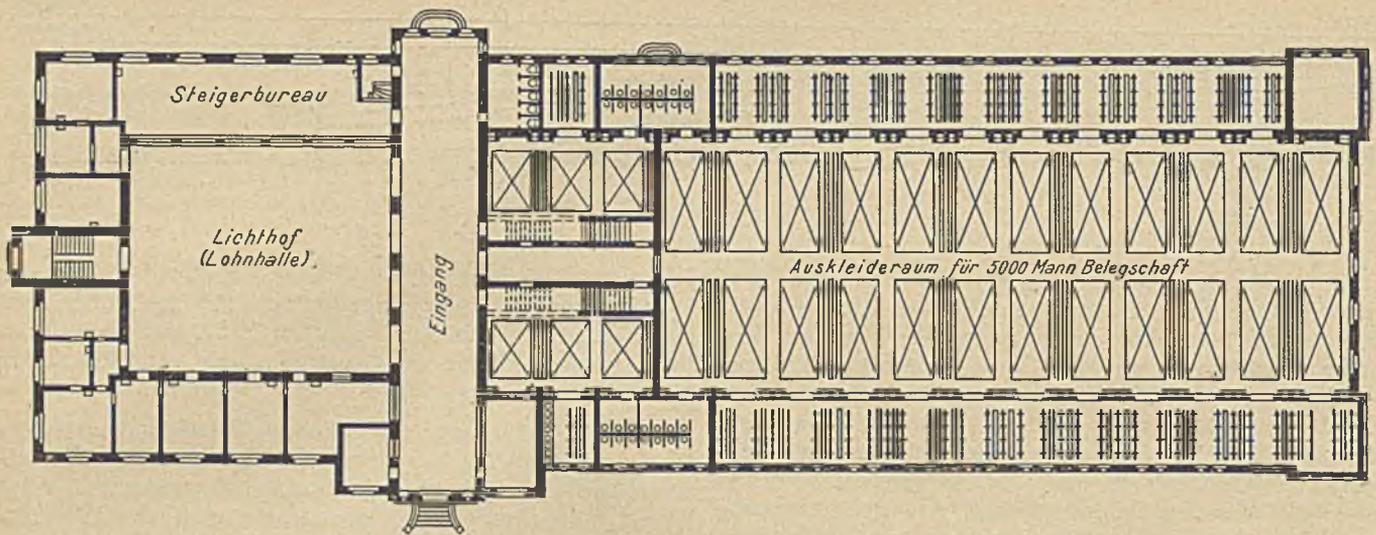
Grundriß des Waschkauen- und Bureaugebäudes.
